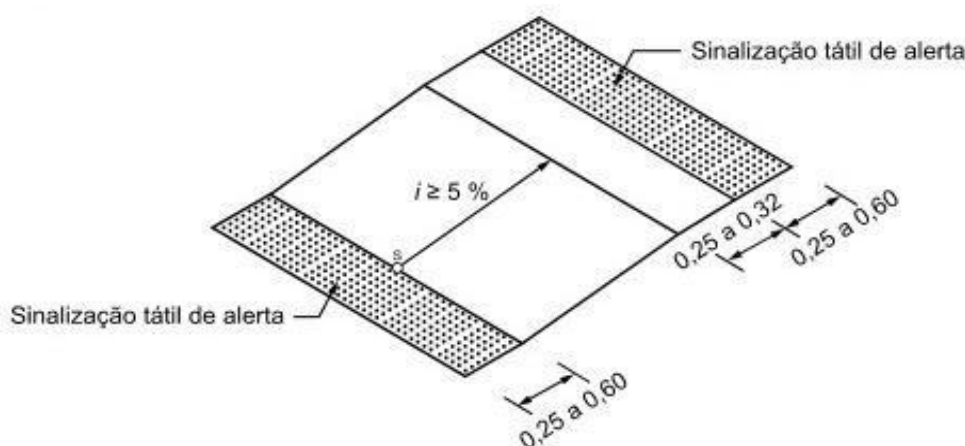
Rampa, vista axonométrica (ABNT NBR 16537/2016, p.13).
